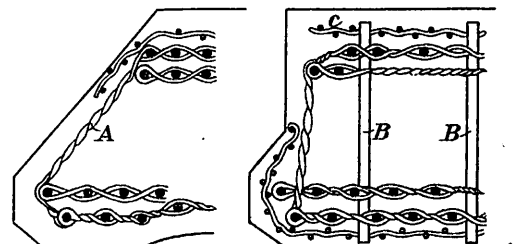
Grundriß. Abb. 13 bis 18. Eisenbetonschwellen
